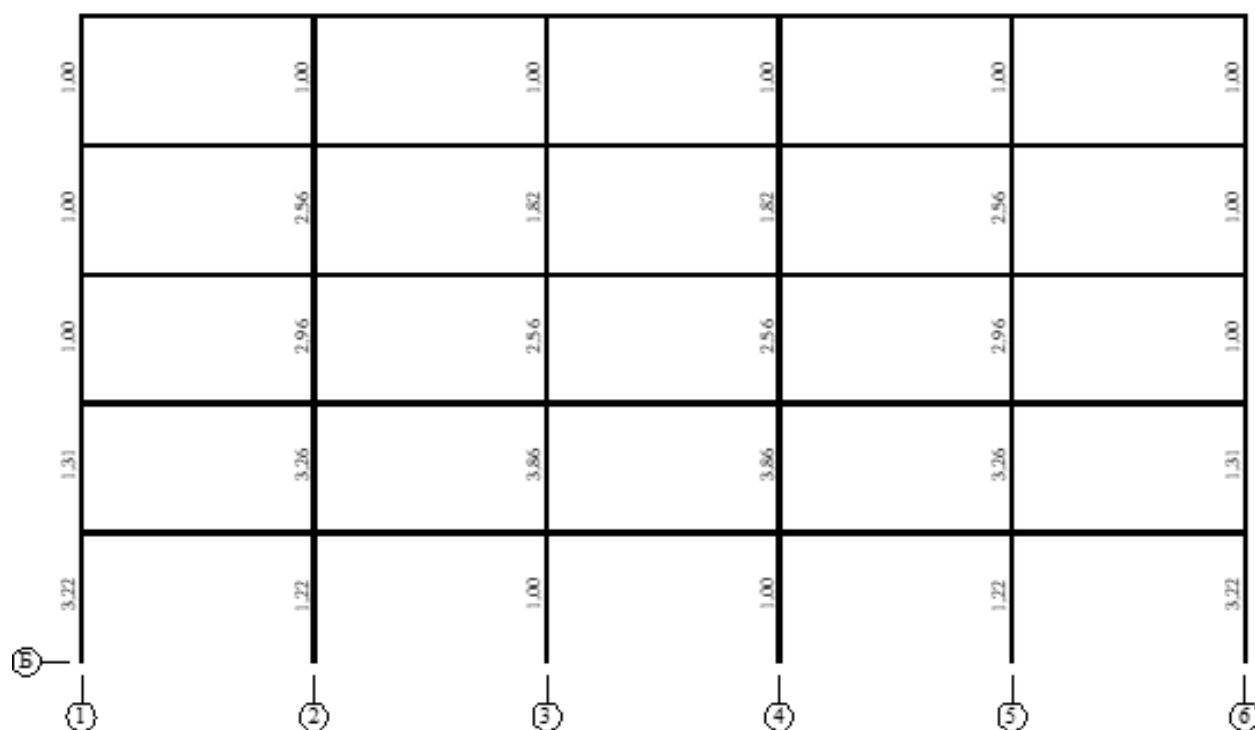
Продольное армирование колонн в соответствии с результатами расчета
